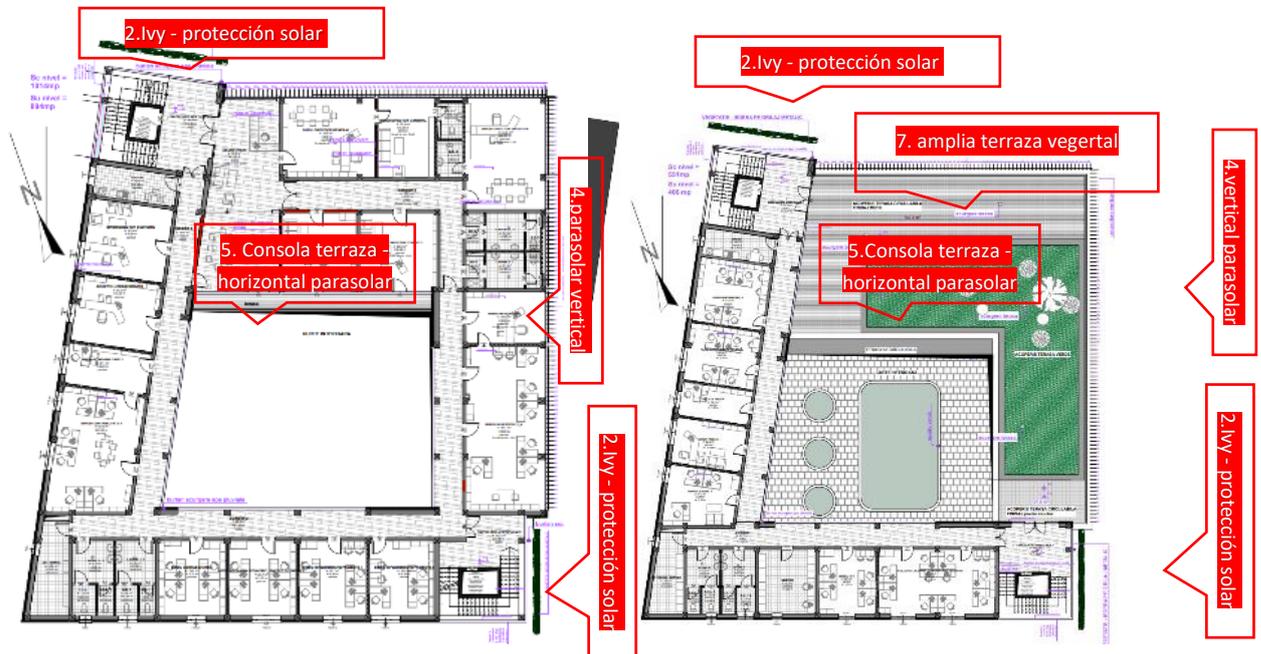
FASE III Dibujos de otoño, concepto Dițoiu Nina-Cristina - Planos de planta niveles superiores superestructura: planta 1, planta 2 variantes ejecutadas: 1. chimeneas solares, 3. cuenca de agua en el patio interior y 6. parasol metálico horizontal (estructura metálica que soporta paneles fotovoltaicos); Se ejecuta 2. Hiedra en una rejilla metálica - protección solar; 4. Parasoles verticales de orientación oeste; 5. Terraza en la consola de orientación sur - parasol horizontal; 7. Terraza vegetación extensa / vegetación alta (bienestar) - comentarios explicativos - color rojo / blanco
